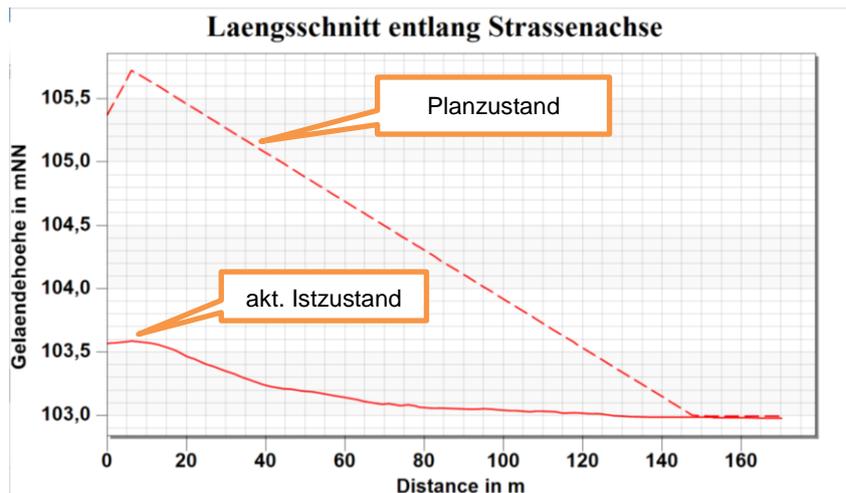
Geländelängsschnitte entlang Straßenachse L 549
